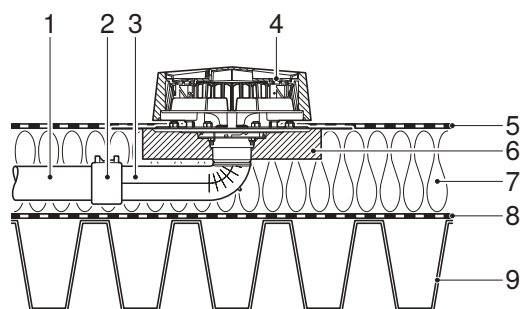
Montage dans toiture en bac acier isolée, sortie horizontale dans l'isolation thermique avec revêtement d'étanchéité et pare-vapeur
